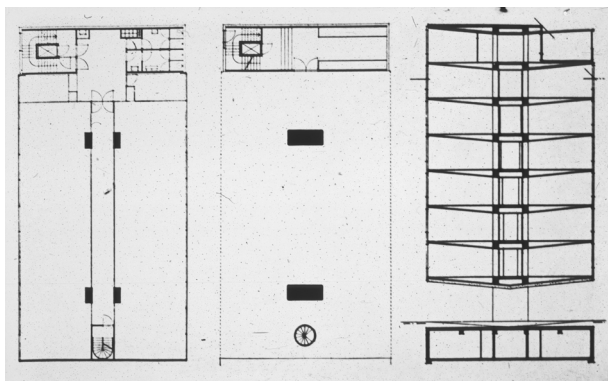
Edifício Jespersen, Arne Jacobsen - plantas baixas e corte
